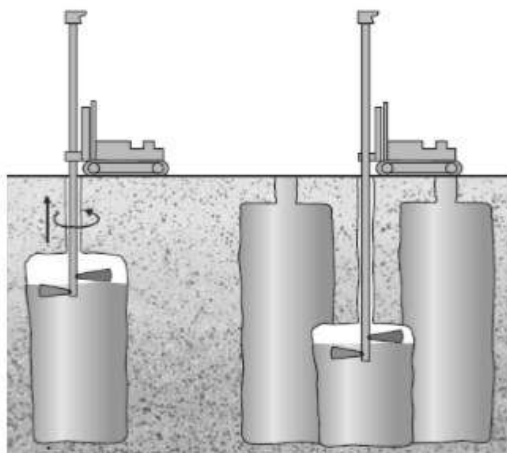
Jet Grouting (Inyección con Chorro de Lechada). Fuente. Suarez (1988). Ingeniera de suelos aplicada a la cimentación (p. 40)
